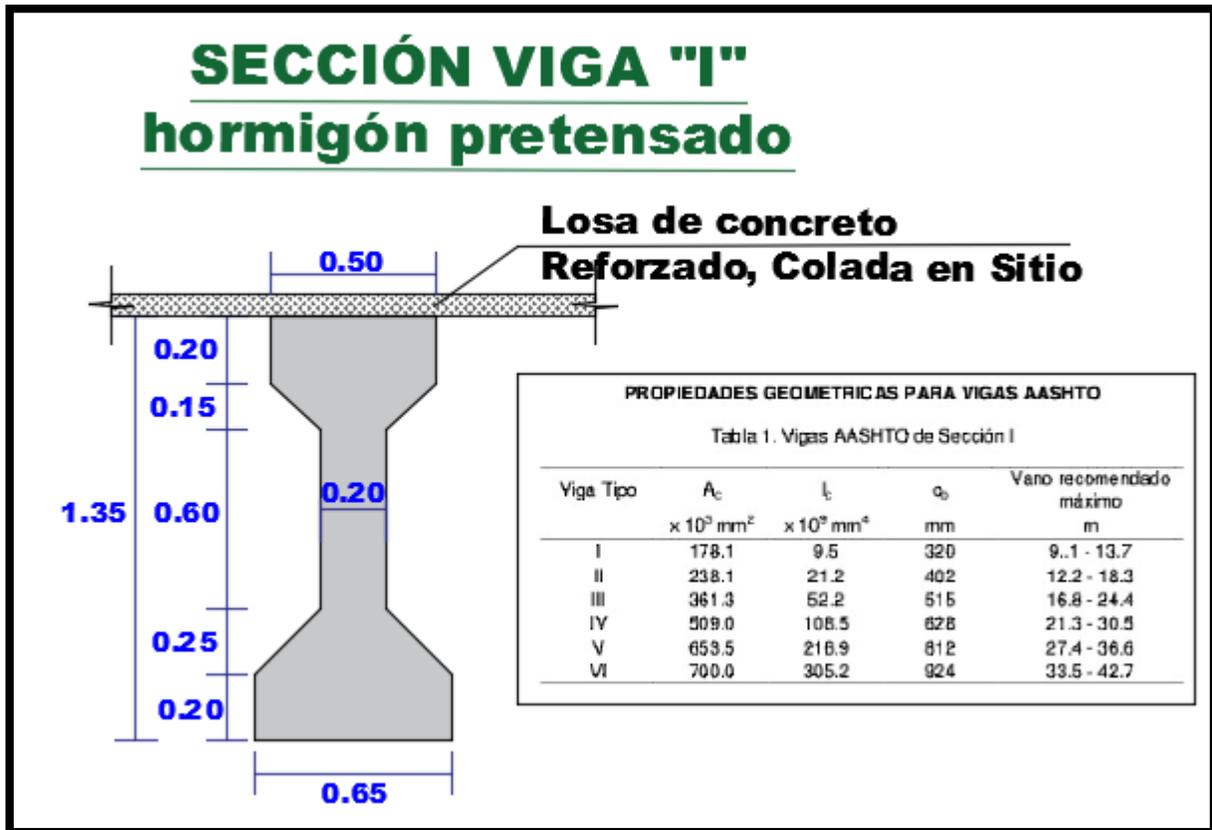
Dimensionamiento de la viga I, Tipo IV. AASHTO.
